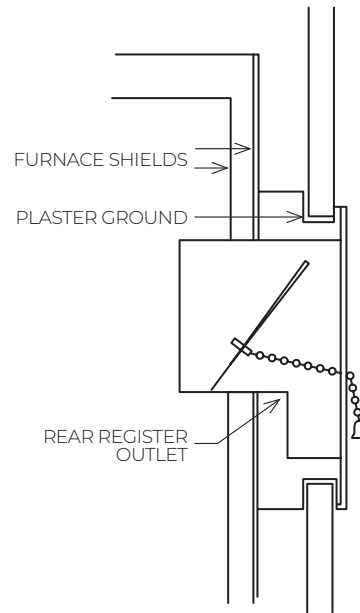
RETIRE LAS PLACAS DE TERMINACIÓN
